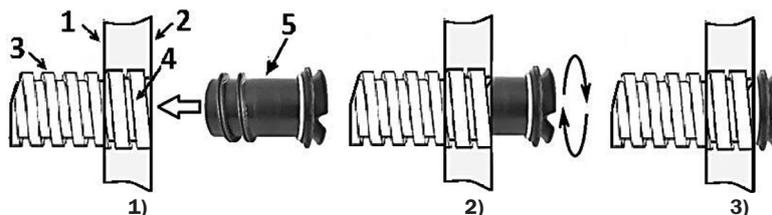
Закрывание трубы ССД-Пайп, введённой в колодец через предустановленную муфту в стену колодца, резьбовой внутренней заглушкой
